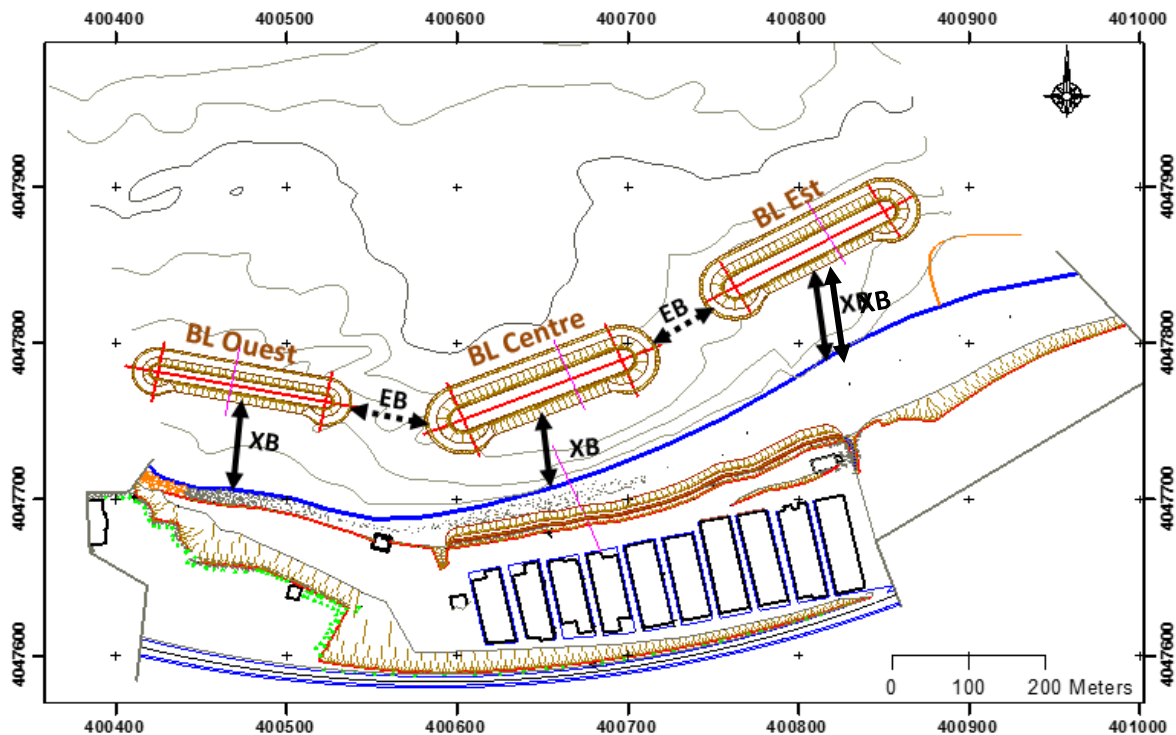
Dimensionnement des ouvrages de protection de la basse plage « plan de masse» (LEM, 2009).
